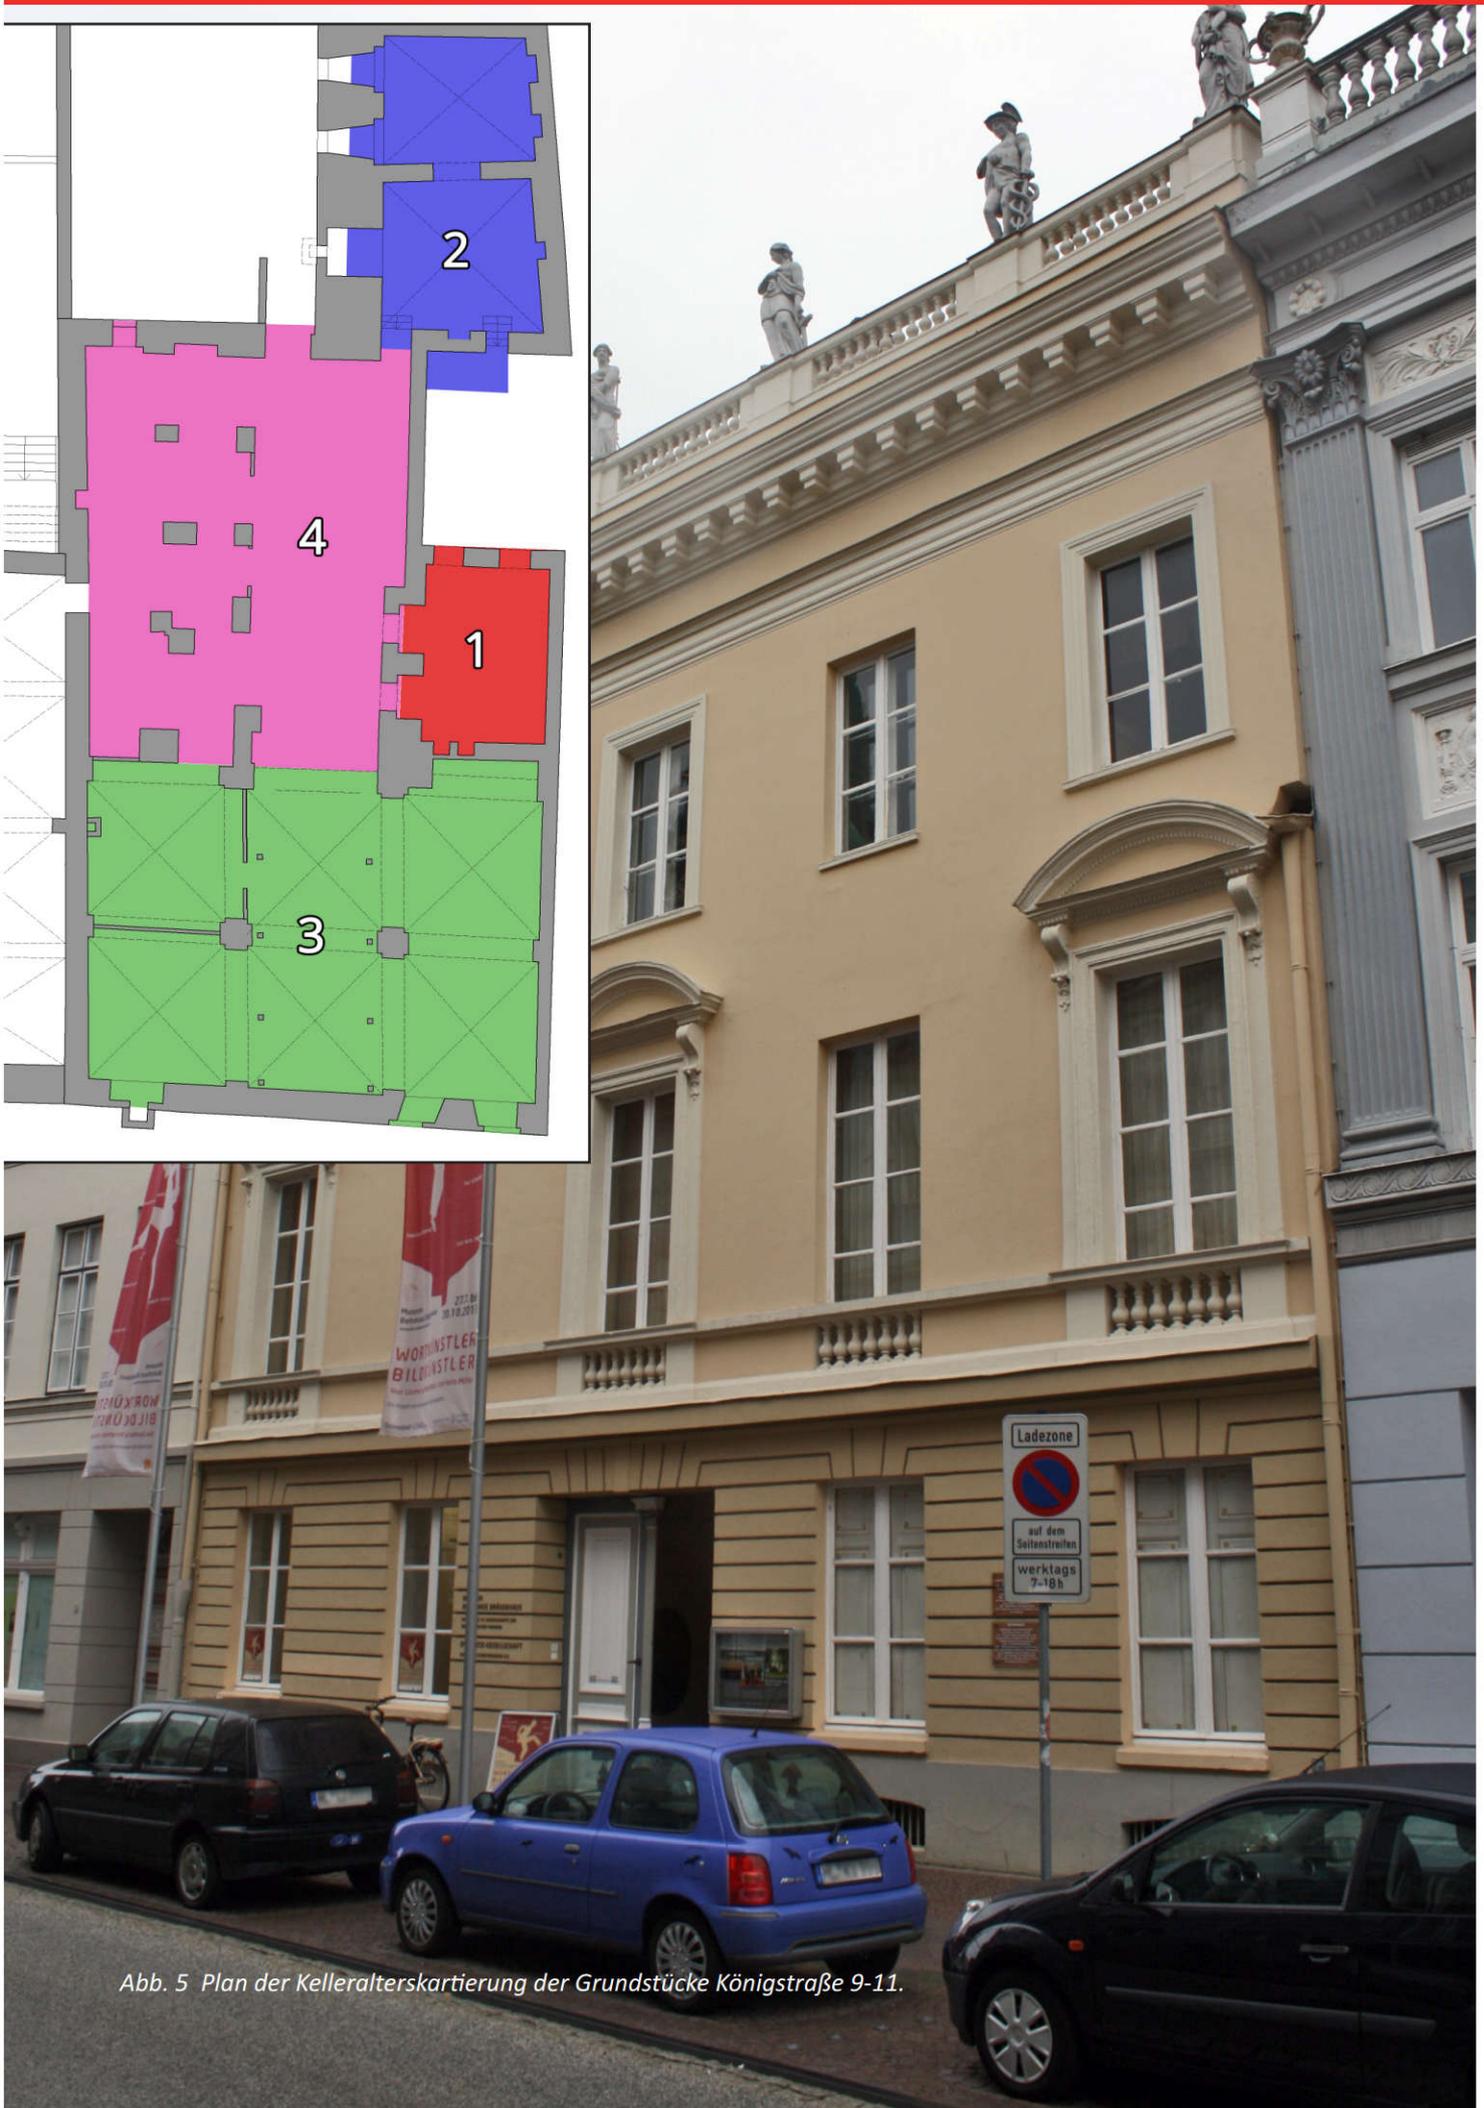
Plan der Kelleralterskartierung der Grundstücke Königstraße 9-11.
